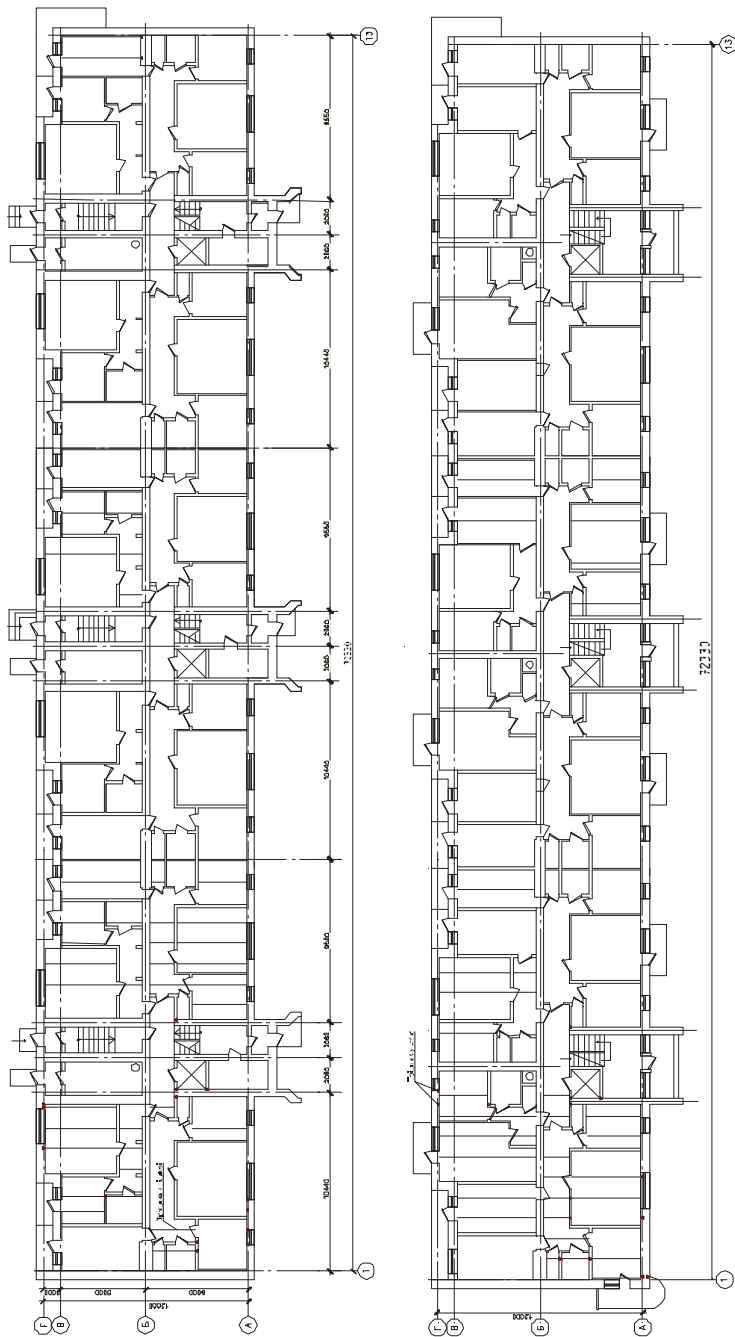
Карта дефектів в перекритті 1-го та 2-го поверхів будівлі
